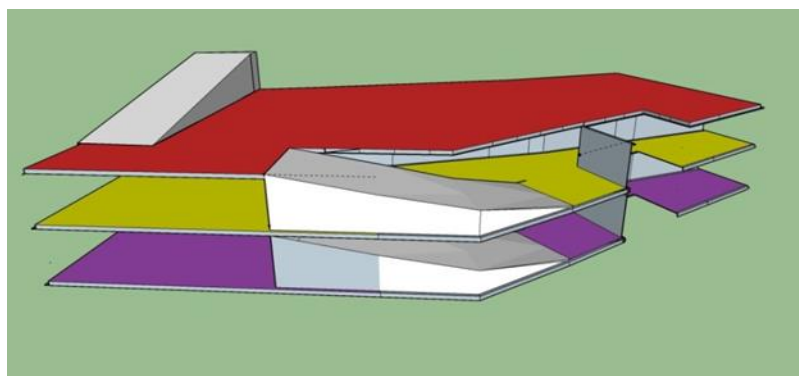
3D montrant les trois niveaux sous-sol du parking.
